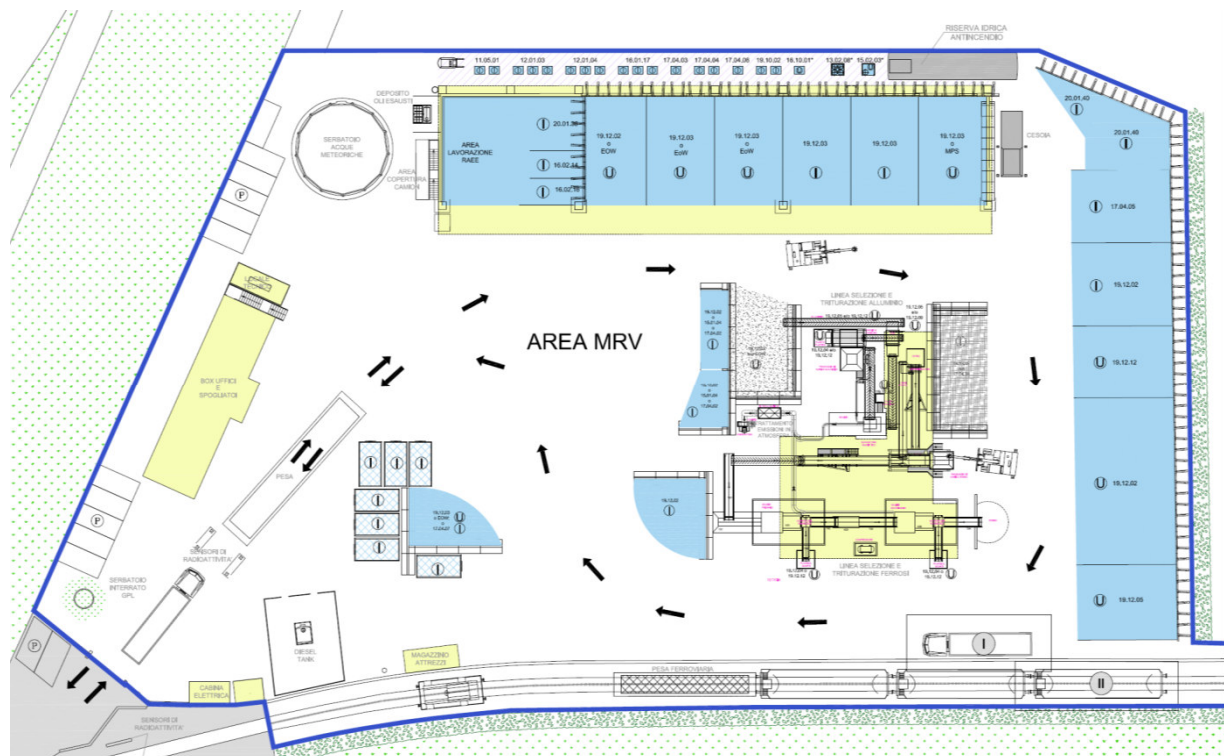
planimetria del sito – in giallo le aree coperte e i fabbricati, in azzurro gli stoccaggi di rifiuti
